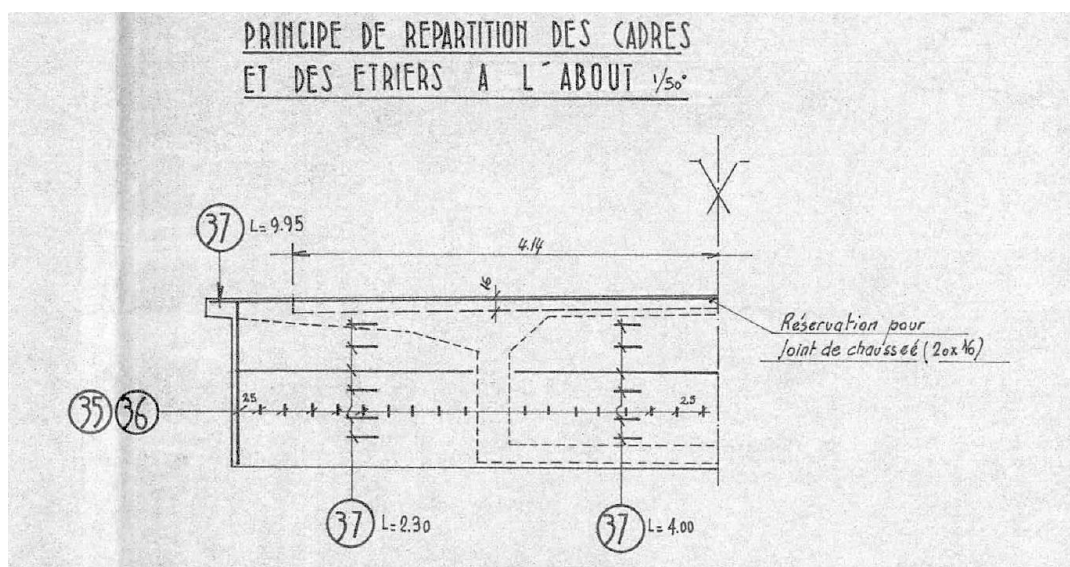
Extrait de plan de ferrailage de l'about - coupe transversale
